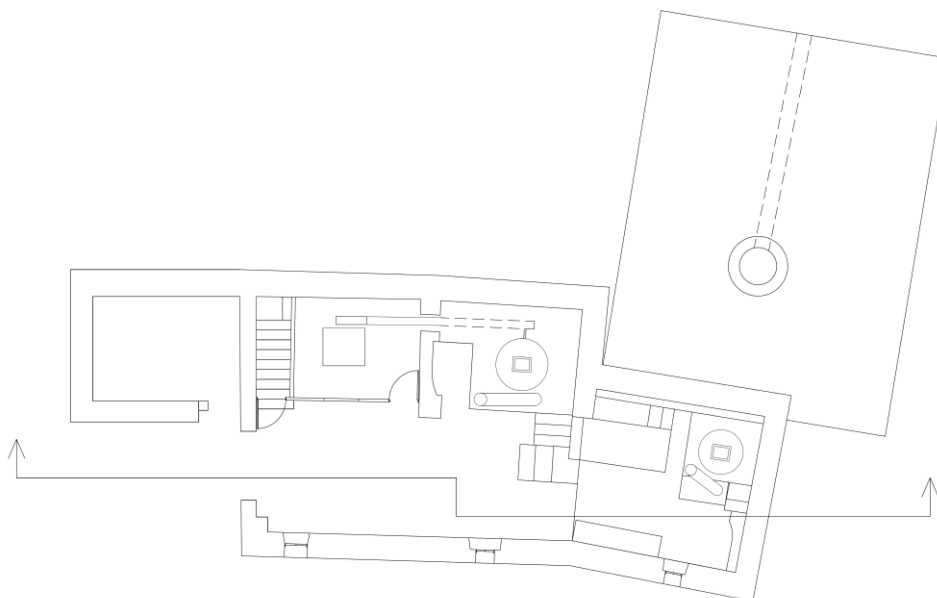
Planta baixa de l'edifici del molí després de la tercera modificació. (Font: Autor.)
